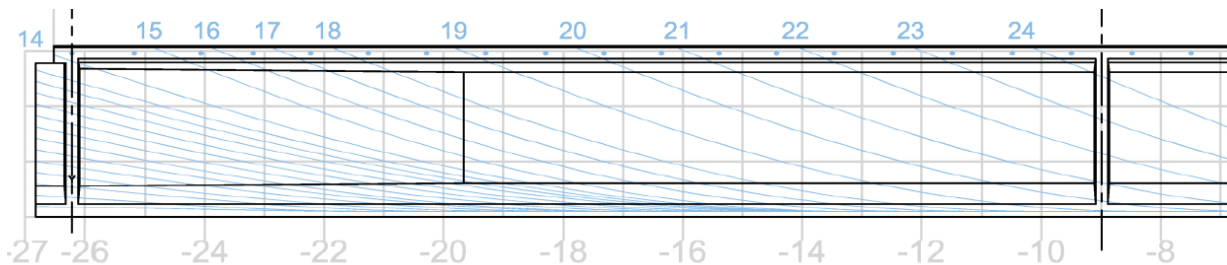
Extrait d'une fiche d'inspection vierge (poutre à 24 câbles)
